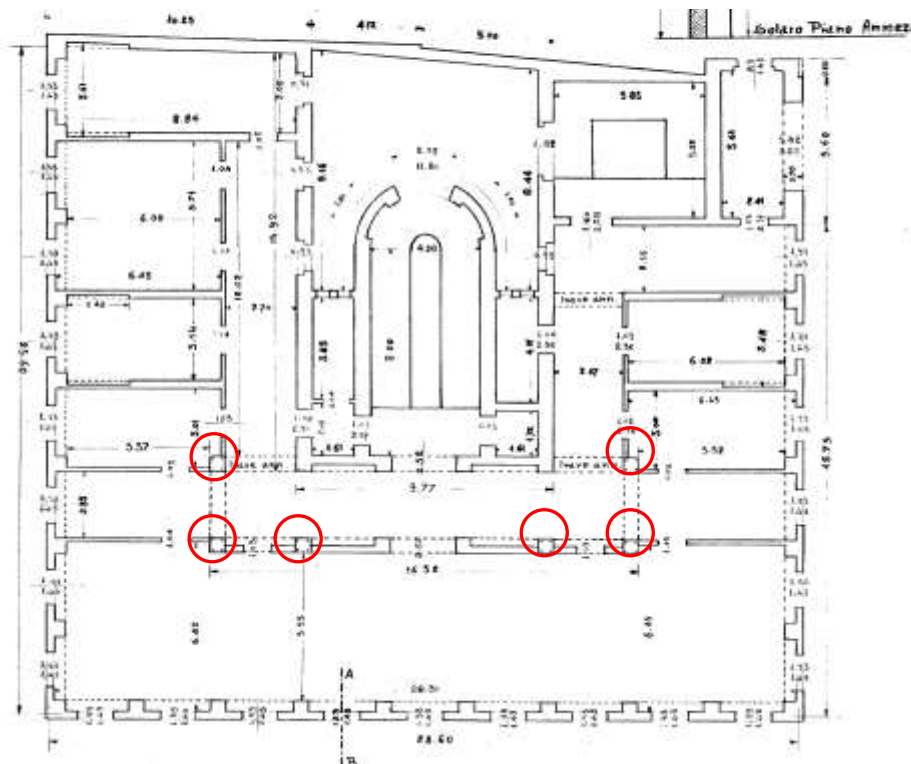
Pianta strutturale del piano primo (indicato come piano ammezzato negli elaborati d'epoca) risalente al 1937, con indicazione degli elementi in c.a.
